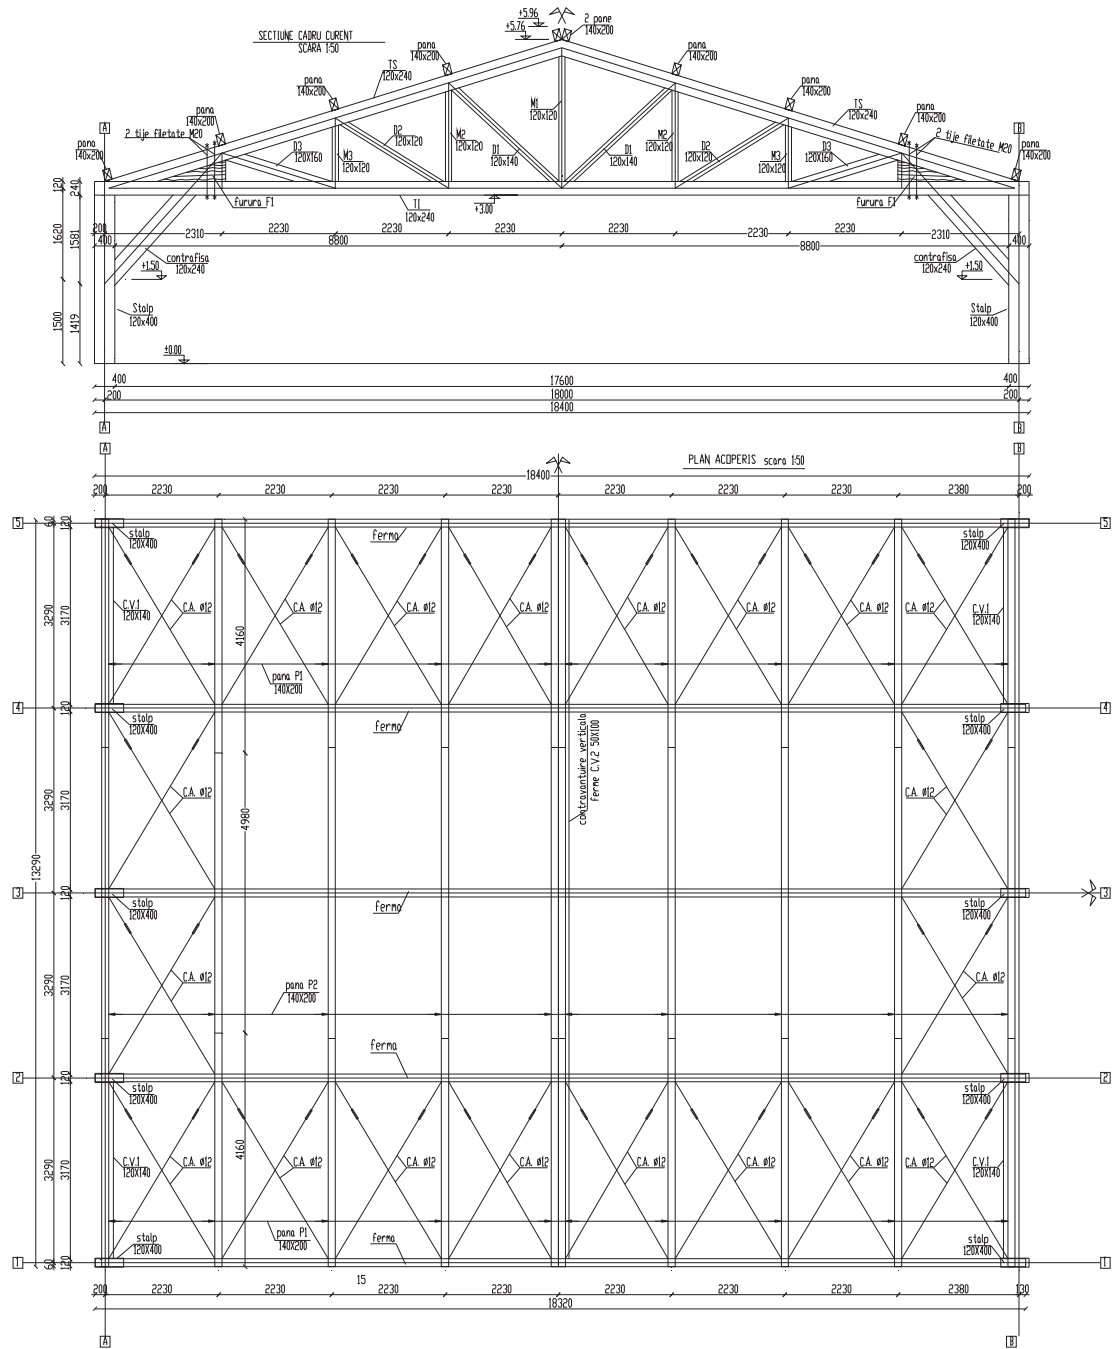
Secțiune transversală și plan structură de rezistență din lemn lamelat încleiat pentru hala tip depozit
